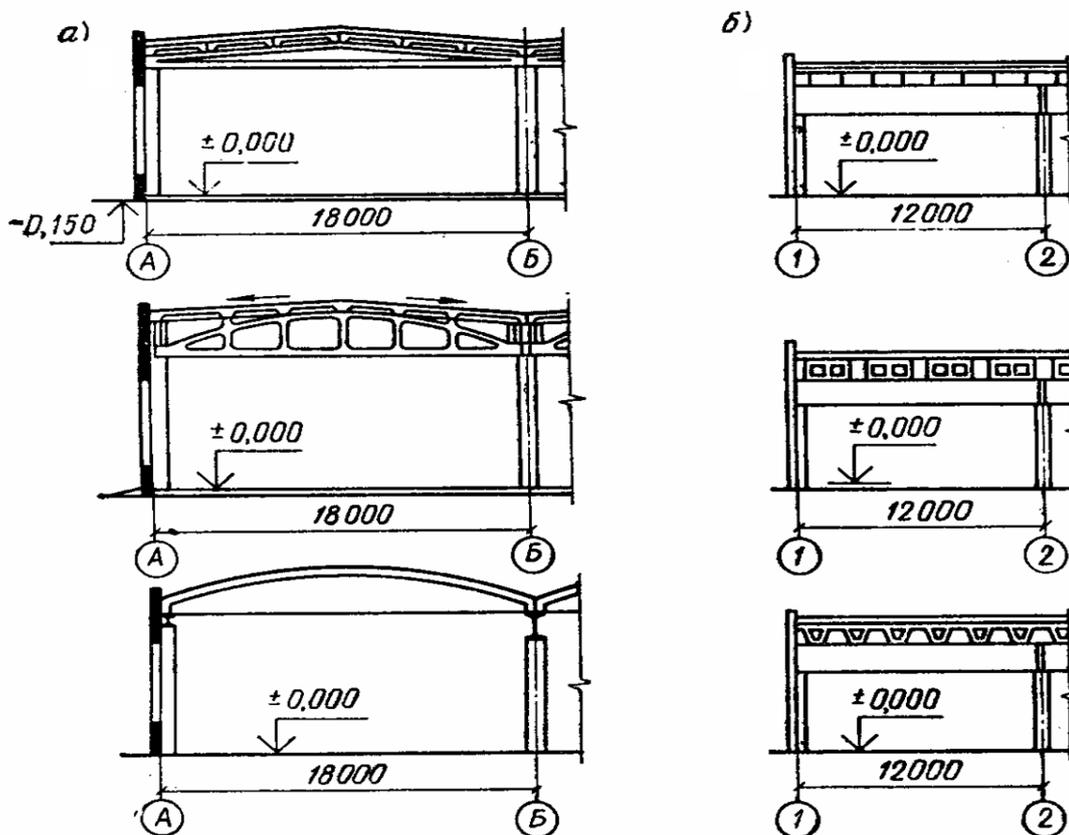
Сборные железобетонные каркасы одноэтажных производственных зданий со скатными (а) и плоскими (б) покрытиями при пролетах 18 и 12 м
